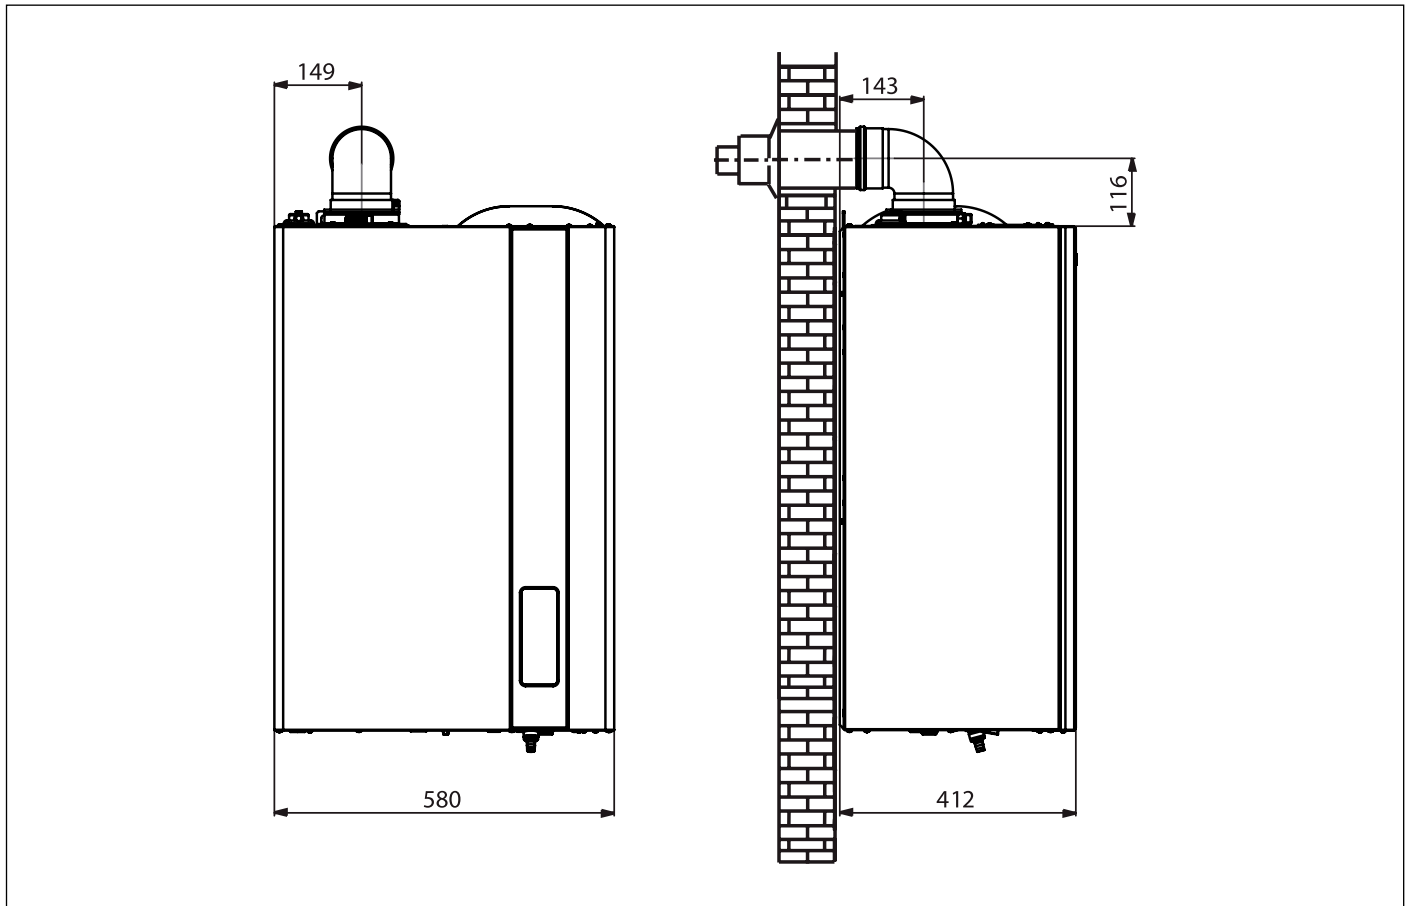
Dimensions des tuyaux coaxiaux type C13 - C33
